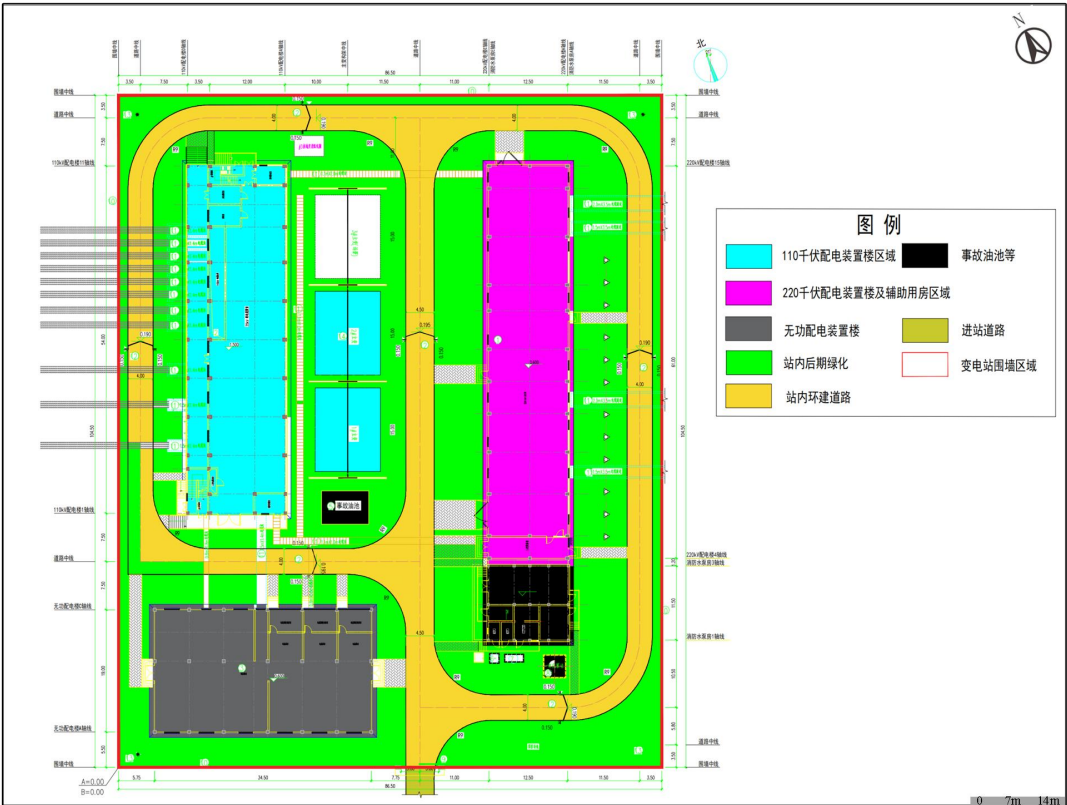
川埠 220 千伏变电站工程总平面布置图
